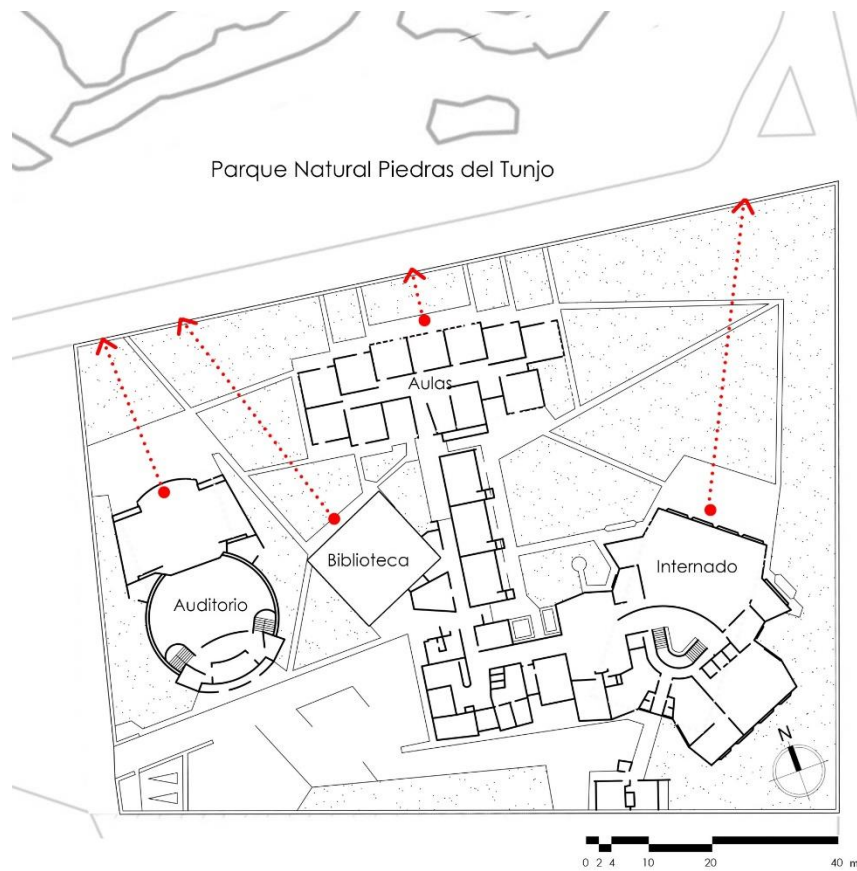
Vista de los volúmenes al paisaje. Elaboración propia (2016)
